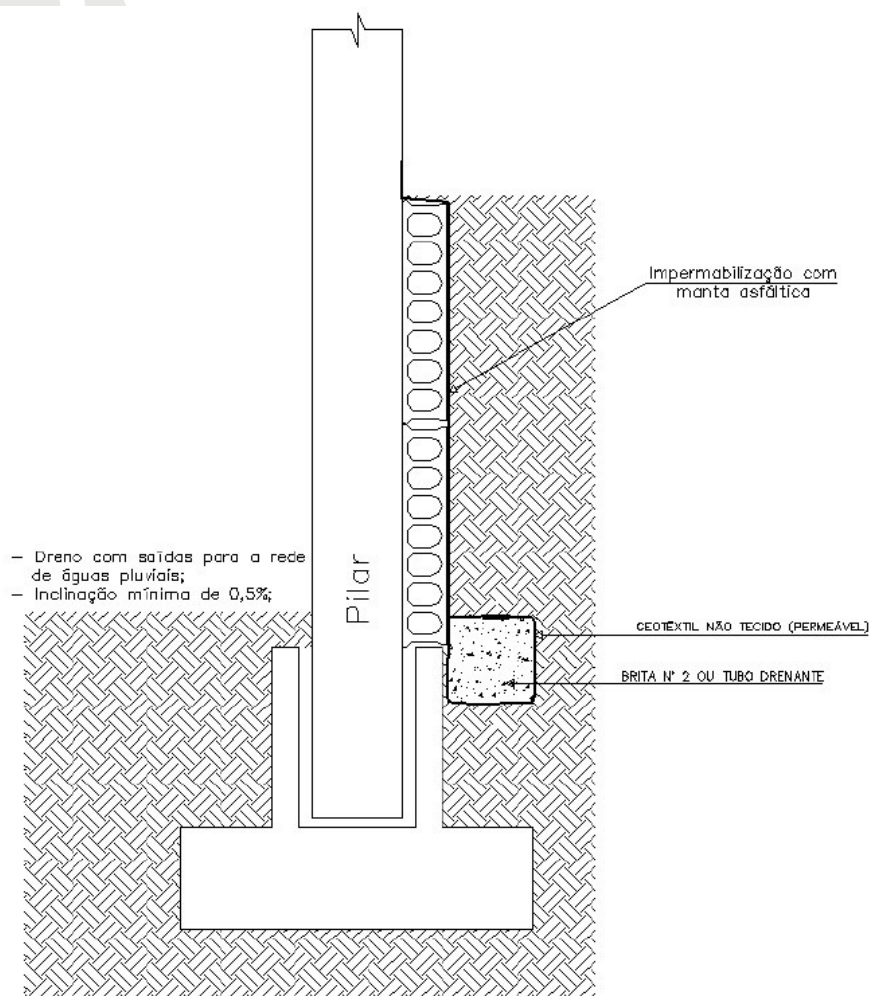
Detalhe genérico (Impermeabilização e dreno)
